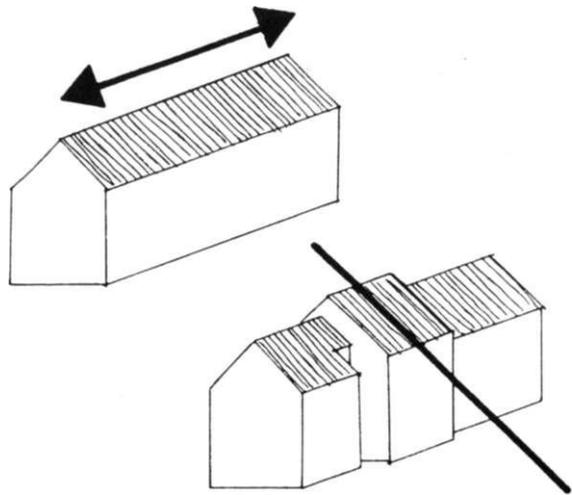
Einfache, klare Formen der Baukörper im alten Dorfkern
